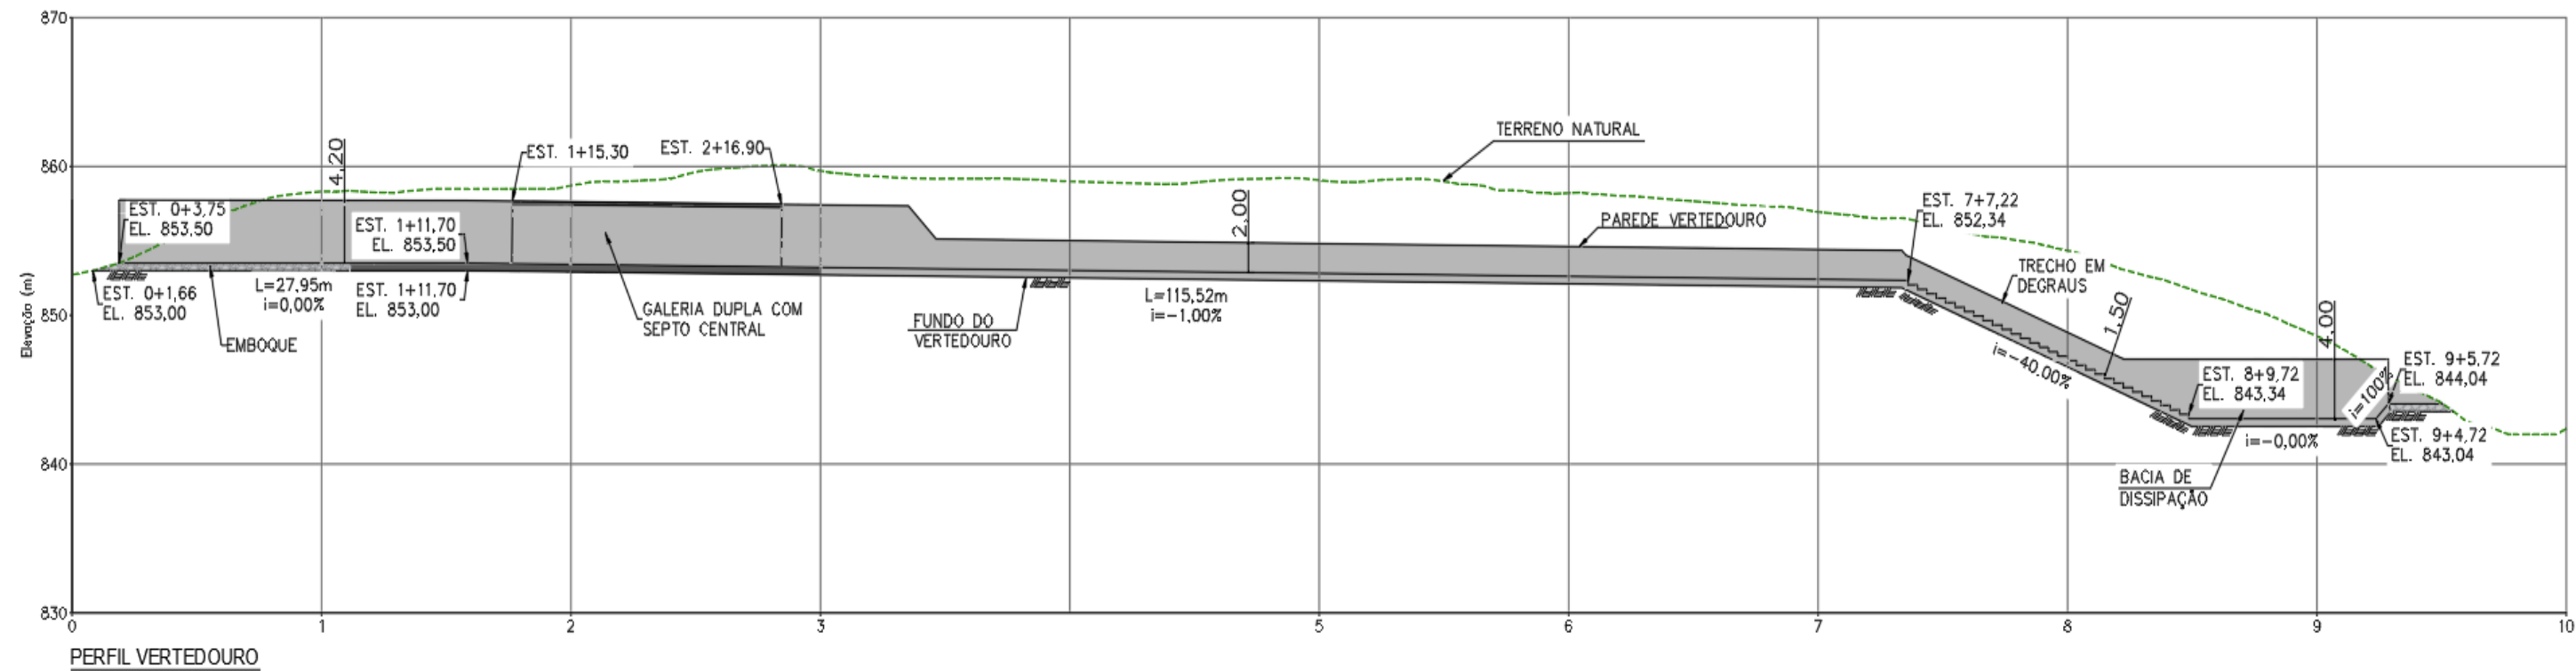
Arranjo Geral - Perfil do Vertedouro de Soleira Livre da Barragem do Quinzinho
